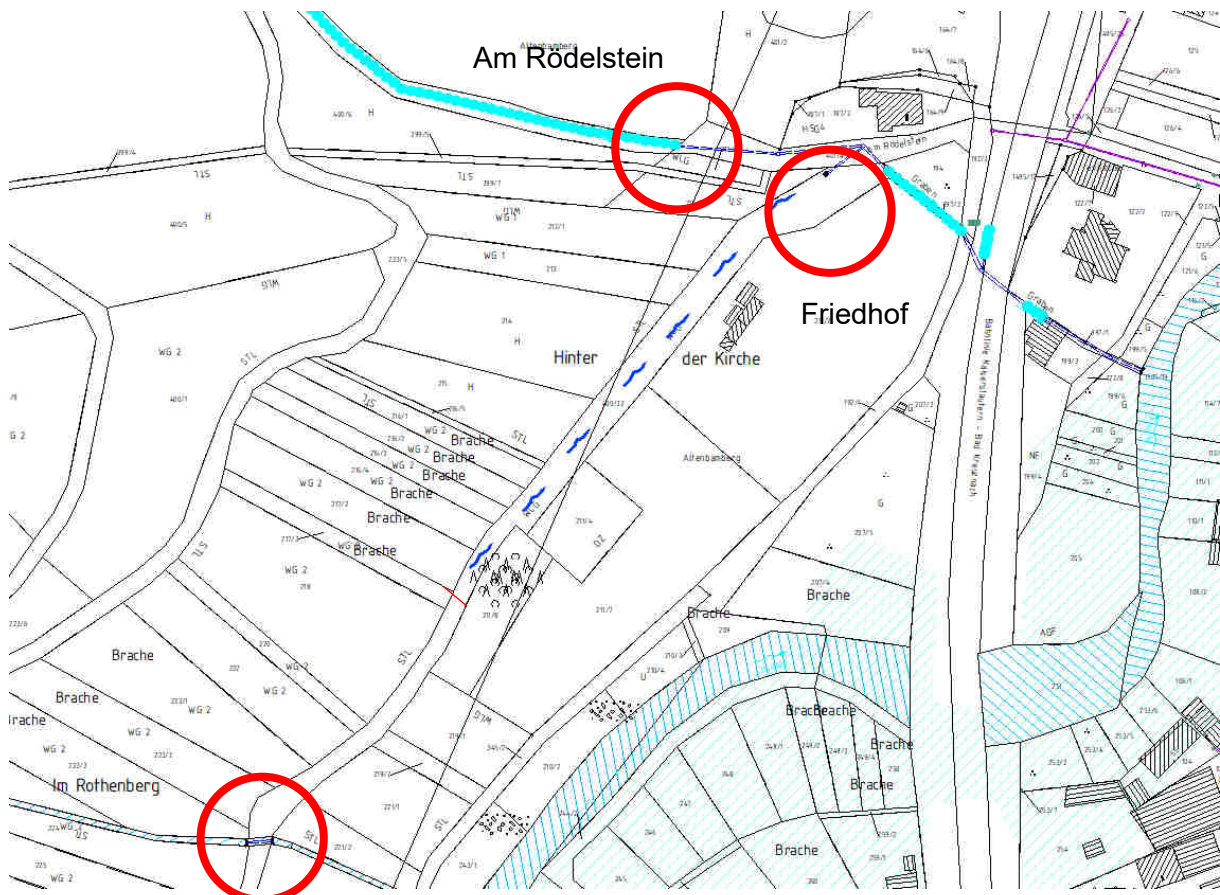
Lageplanausschnitt "Am Rödelstein"
